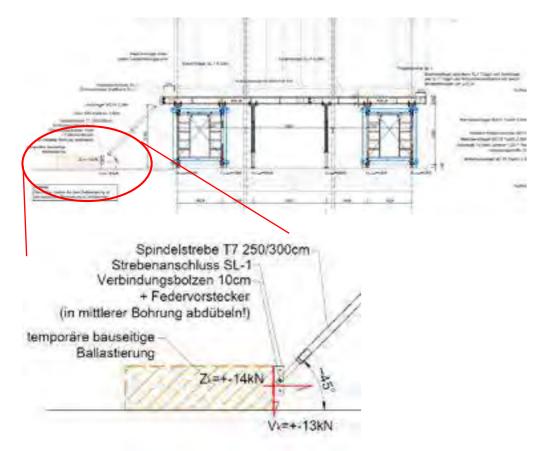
Screenshot aus dem Plan 224-016371-1001.pdf
